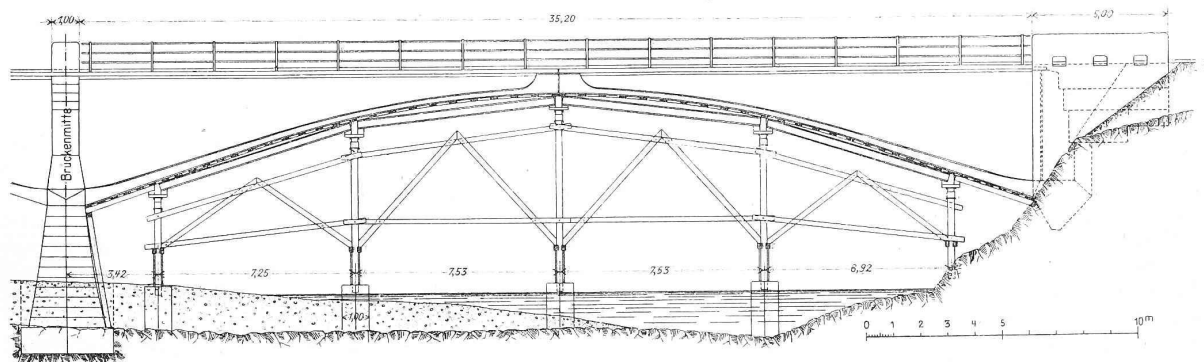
Ansicht einer Brückenöffnung mit dem Lehrgerüst. — Masstab 1:250.
